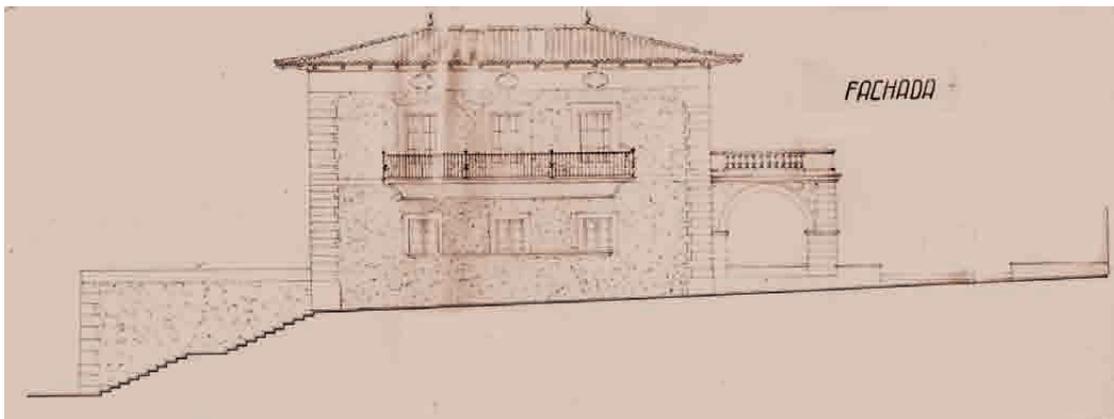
Alzado de la fachada proyectada por Francisco Casas para el Ayuntamiento de Calvià.
